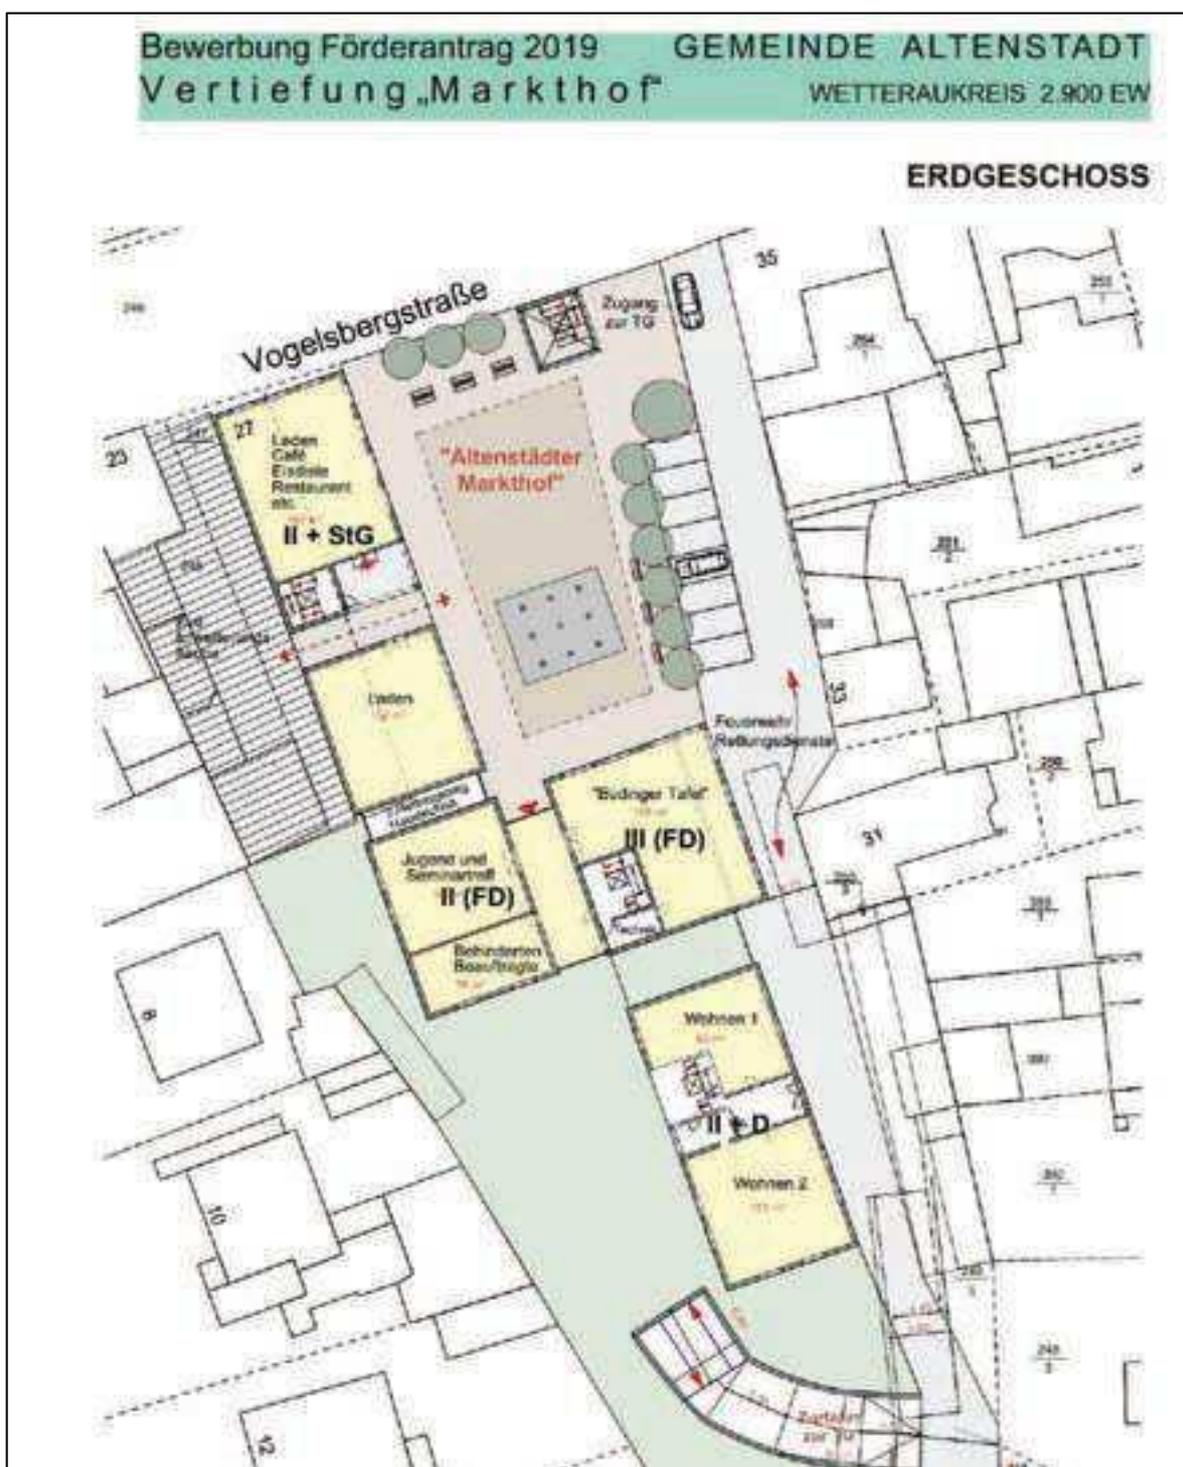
Planungsskizze Eberhardtgelände Erdgeschoss, Quelle: Studie „Vertiefung Markthof“ 2019
